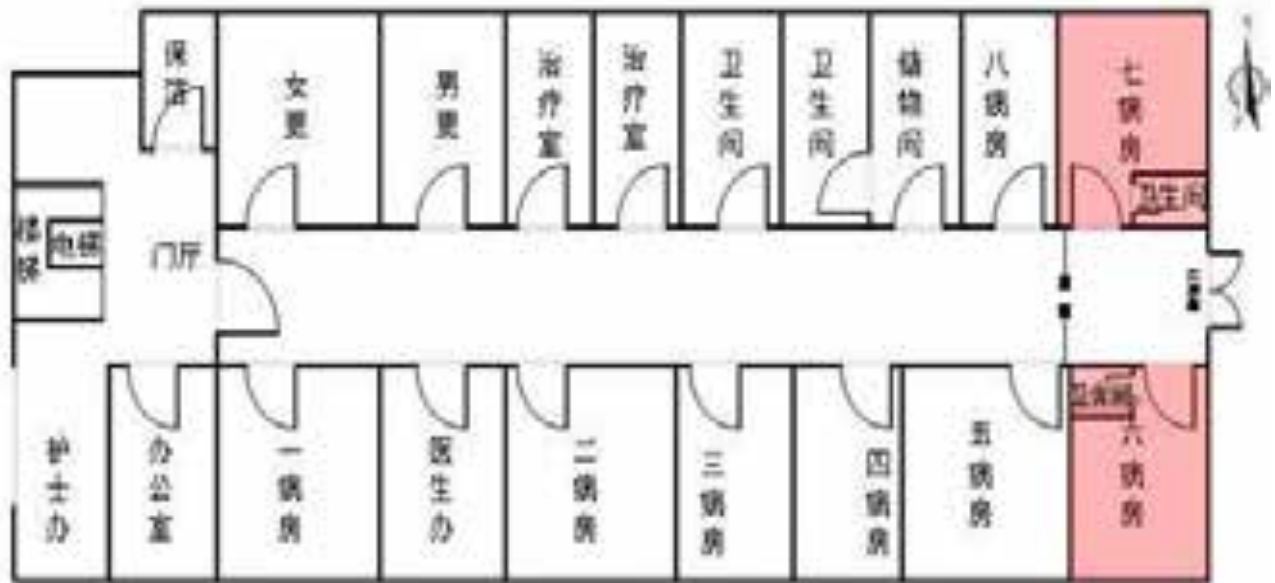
影像楼二层平面布置示意图(红色区域为本项目主要涉及核素的房间)
